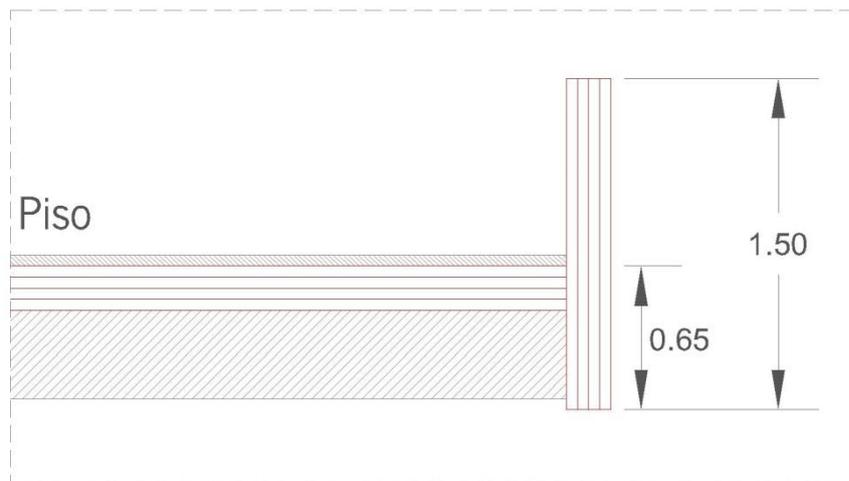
Colocação da Viga de MLCC acima da Laje Estrutural
